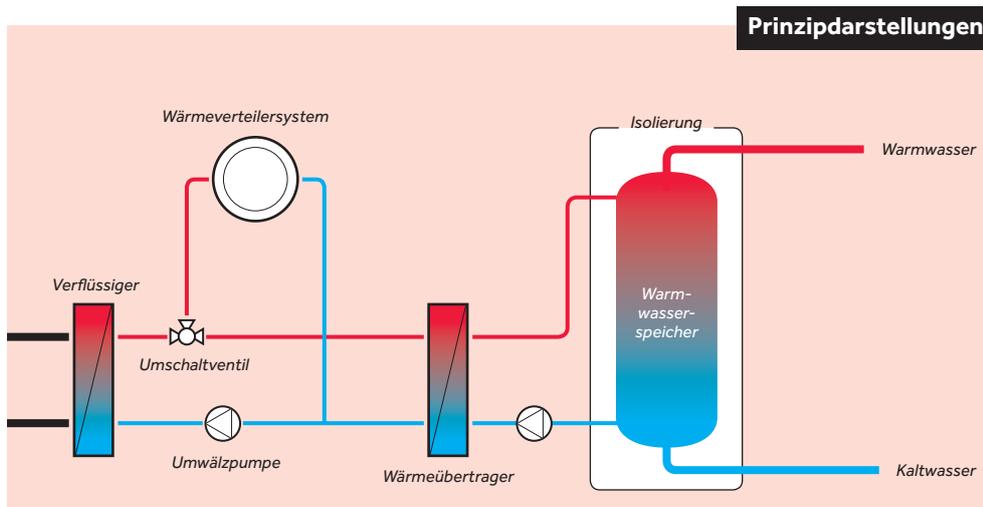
Prinzipdarstellung einer Warmwasserbereitung mit einem externen Platten-Wärmeübertrager *Quelle: AIT 2013
